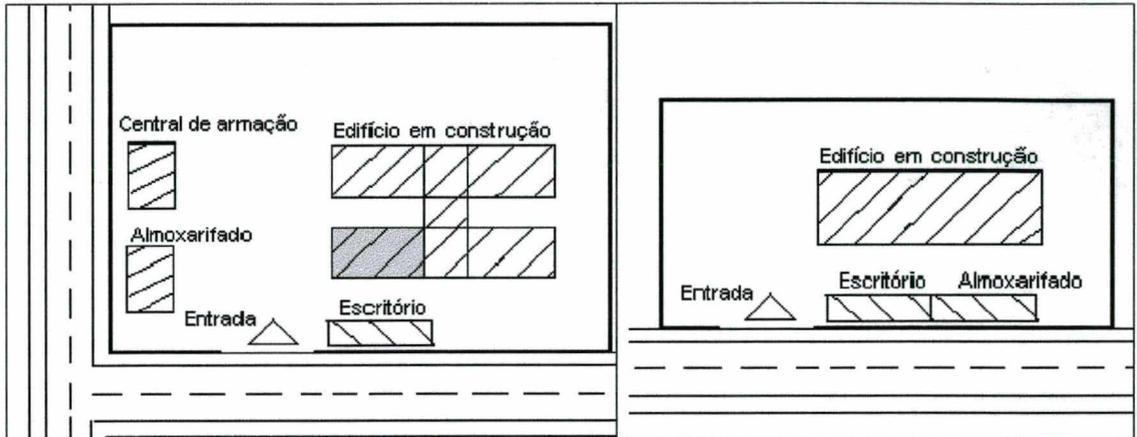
Layout do canteiro de obras da laje com vigotas treliçada 1 e 2 respectivamente.
